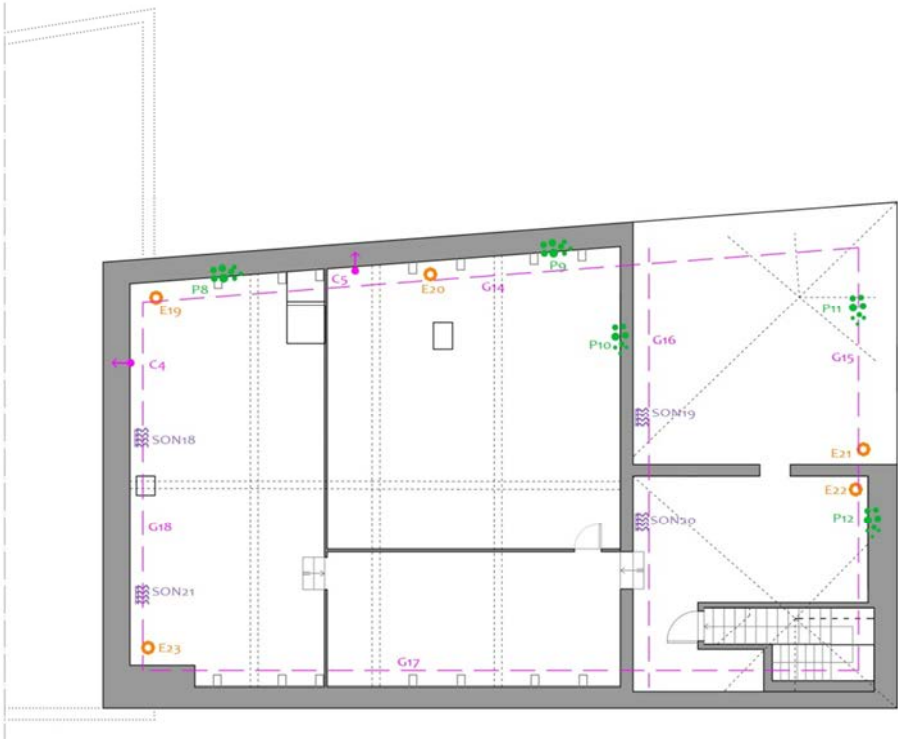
Proposta di indagini, pianta piano sottotetto.
